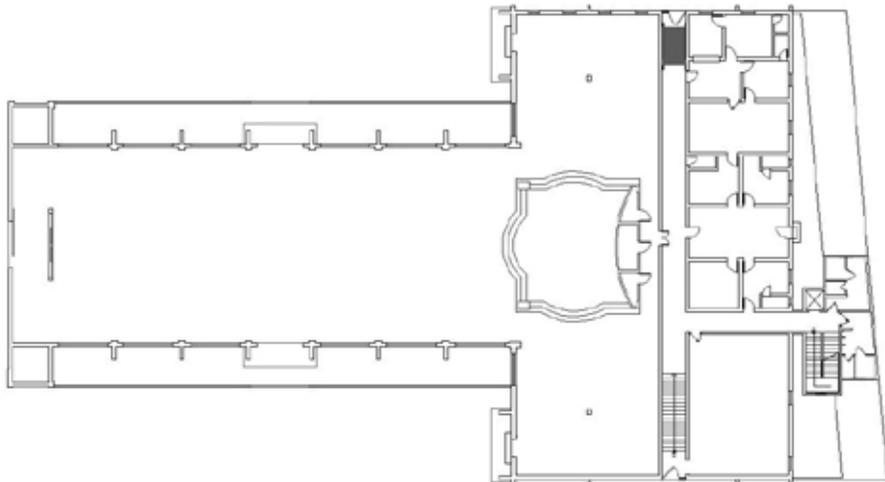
Planta da Igreja Santa Rita de Cássia - Proposta.
